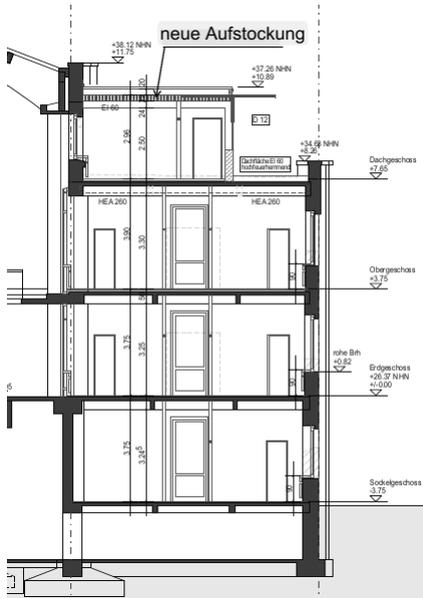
Aufstockung Dachgeschoss [Triade Architekten]
